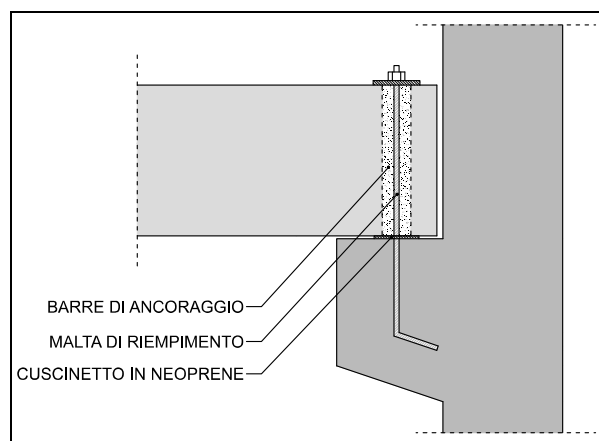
Esempio di connessione trave-pilastro tipica della prefabbricazione italiana.
